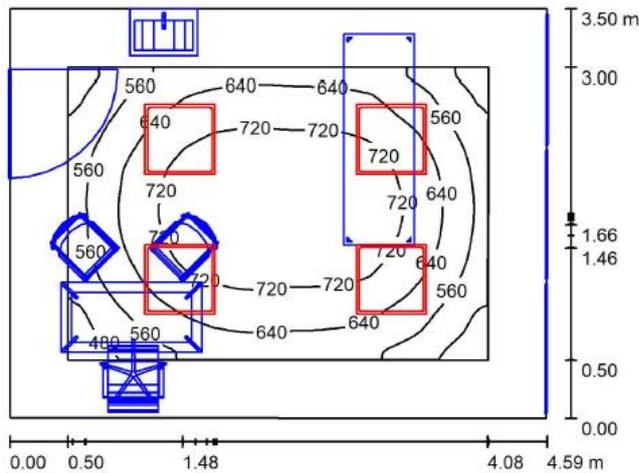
Rappresentazione isolinee (illuminazione costante) in pianta.
